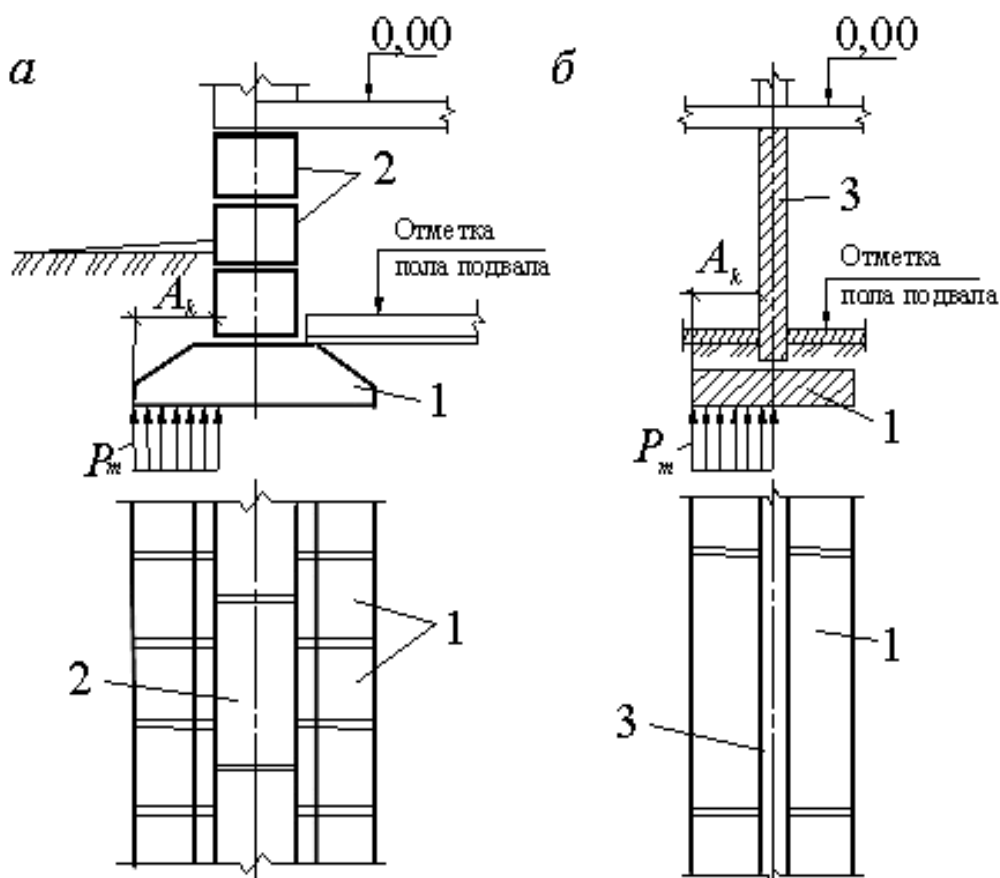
Сборные ленточные фундаменты: 1- фундаментная плита; 2- стеновой фундаментный блок; 3 – стеновая панель подвала
